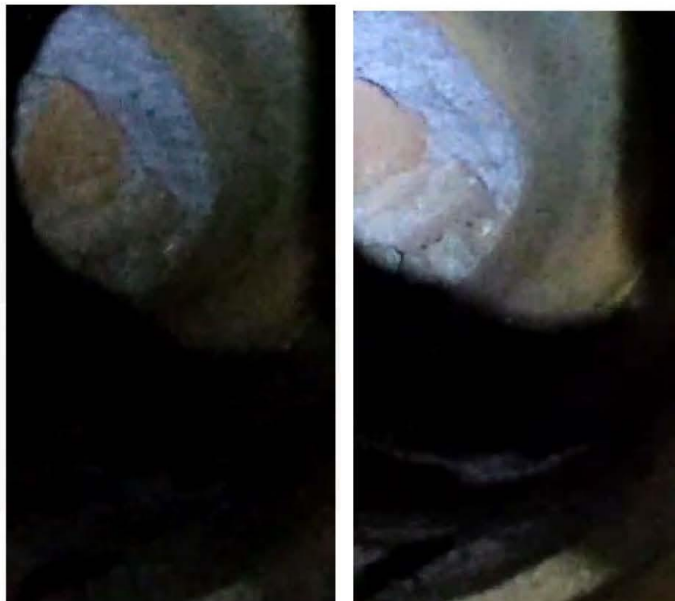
Concreto que escorreu para dentro da tubulação DN 400mm
